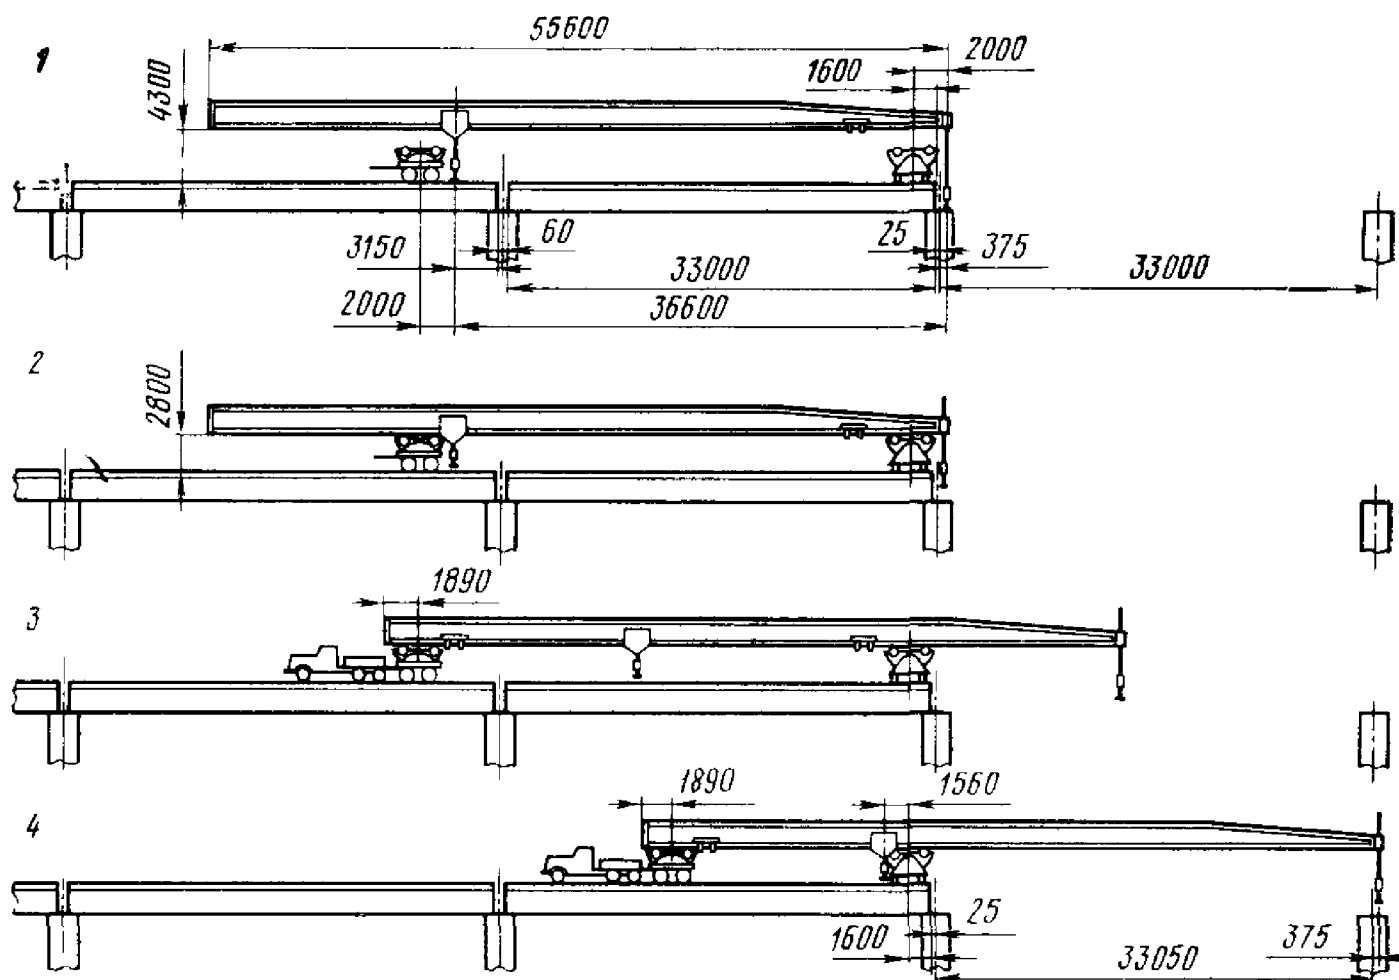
Схема надвигки крана КШМ-63 в пролет моста
